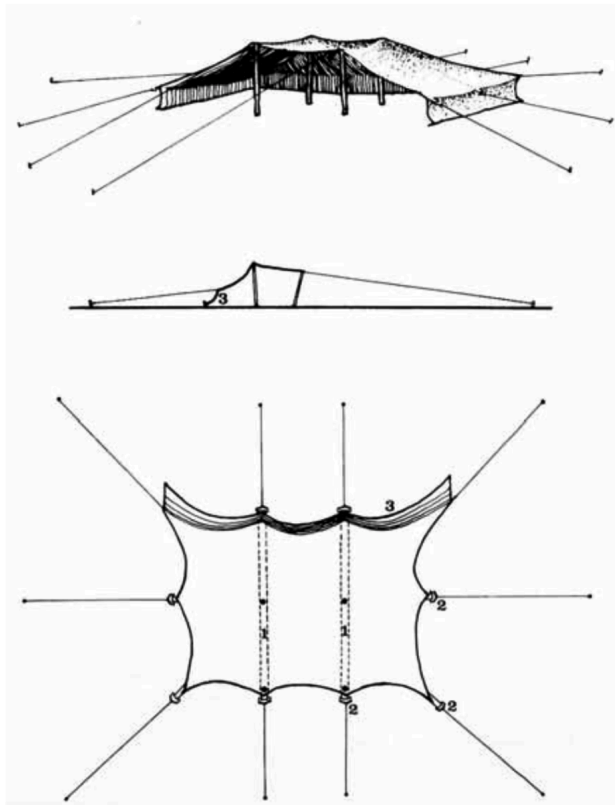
Tienda negra de la zona norte del desierto sirio. Vista, sección y planta
